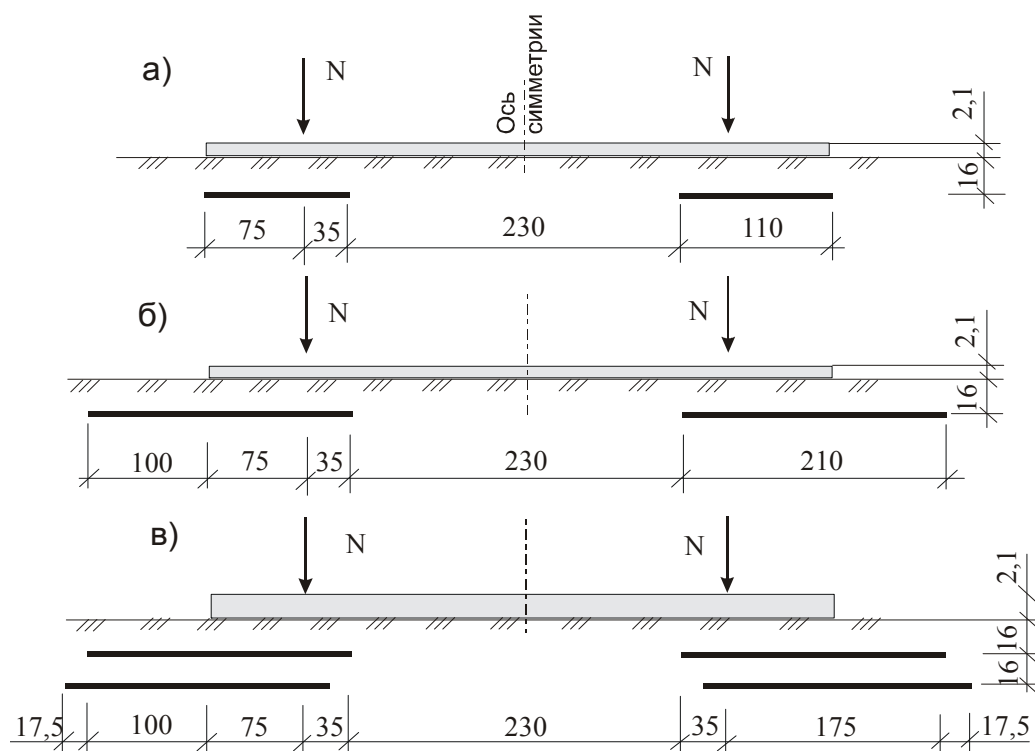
Схема нагружения модели гибкого фундамента и расположения армирующих прослоек
